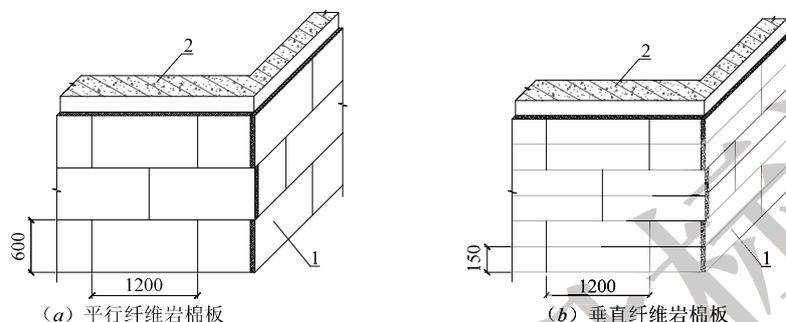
墙体转角排板示意（尺寸单位：mm）
